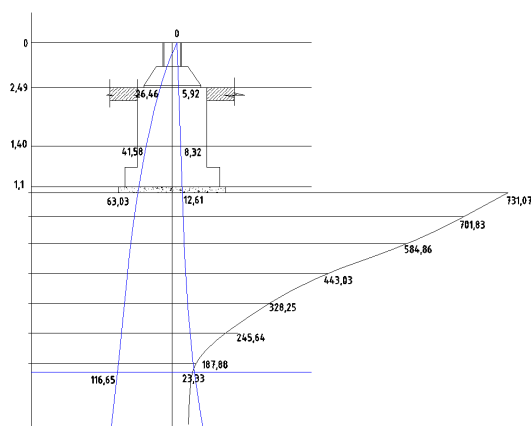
Определения осадки фундамента для средней колонны
